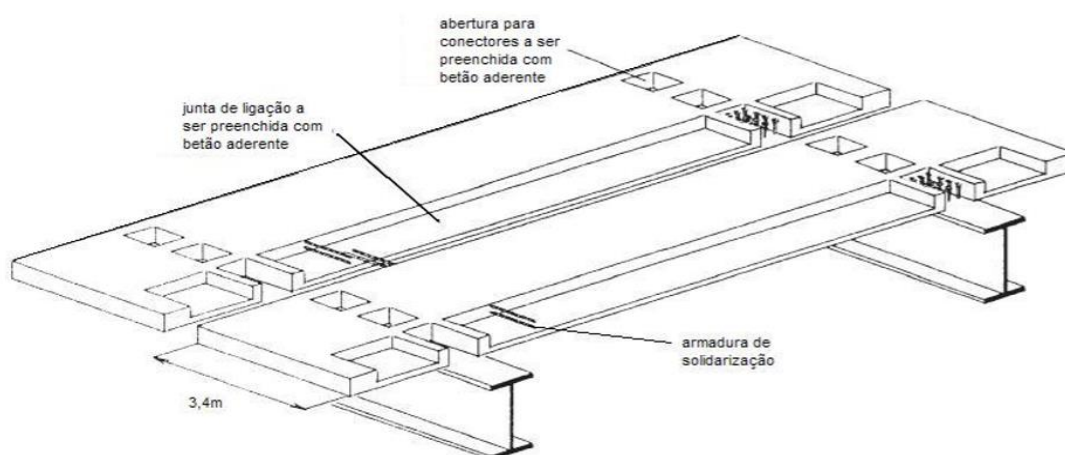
Utilização de pré-lajes na construção de um tabuleiro misto [14]
